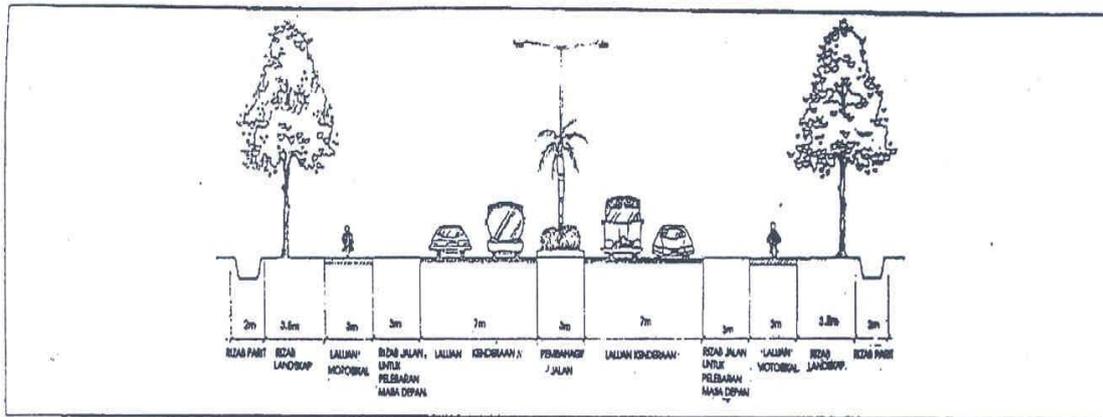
Rizab Landskap Jalan Tempatan (12m)
